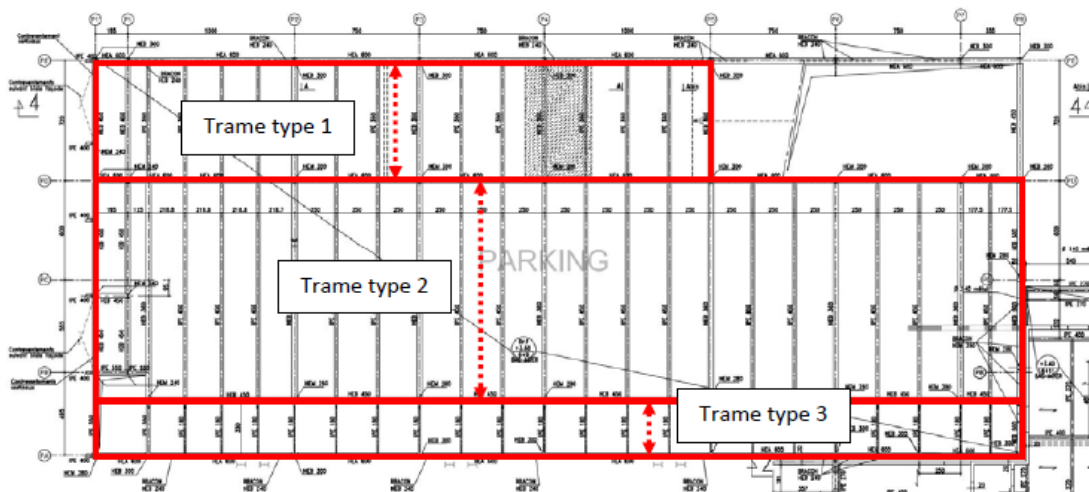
Plan de l'ossature du niveau RDC du parc de stationnement en superstructure
